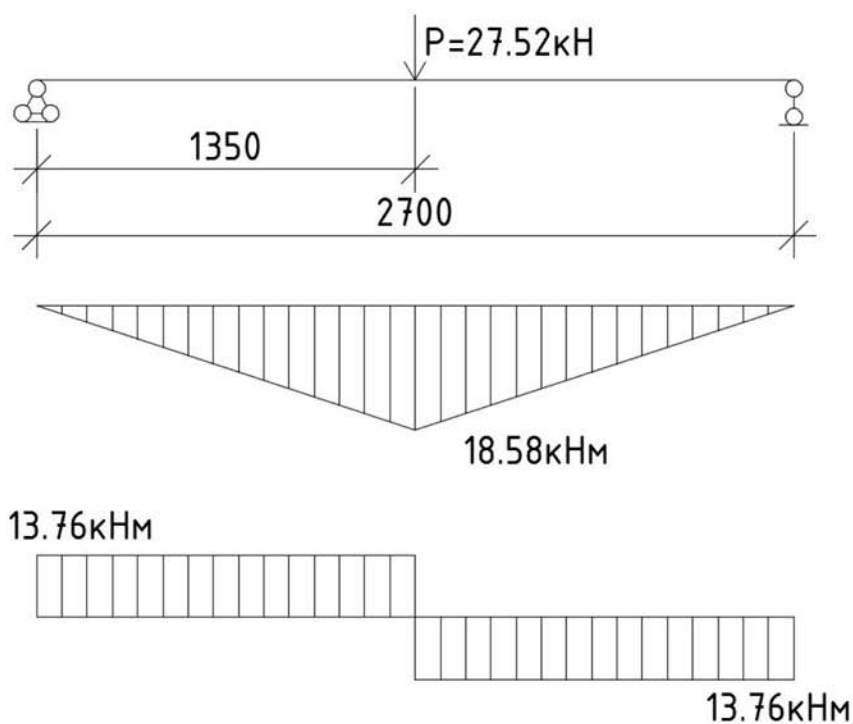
Расчетная схема, эпюры момента и поперечной неусиленной балки Б2
